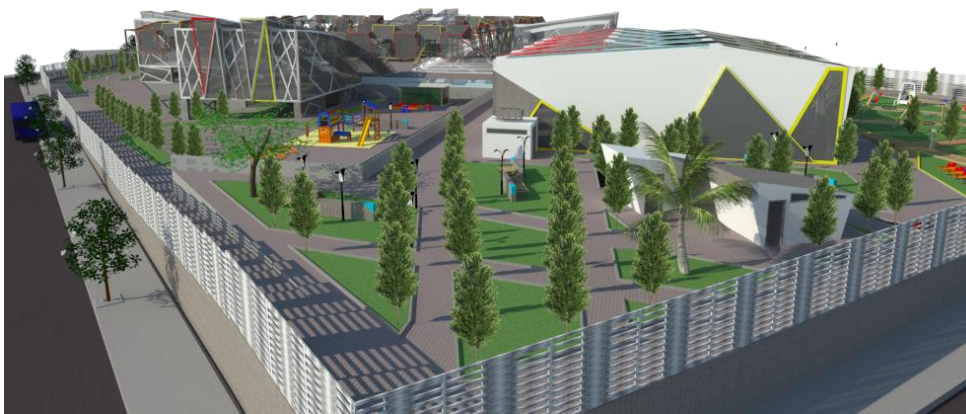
Render área verde y zona de descanso junto a la piscina cubierta.
